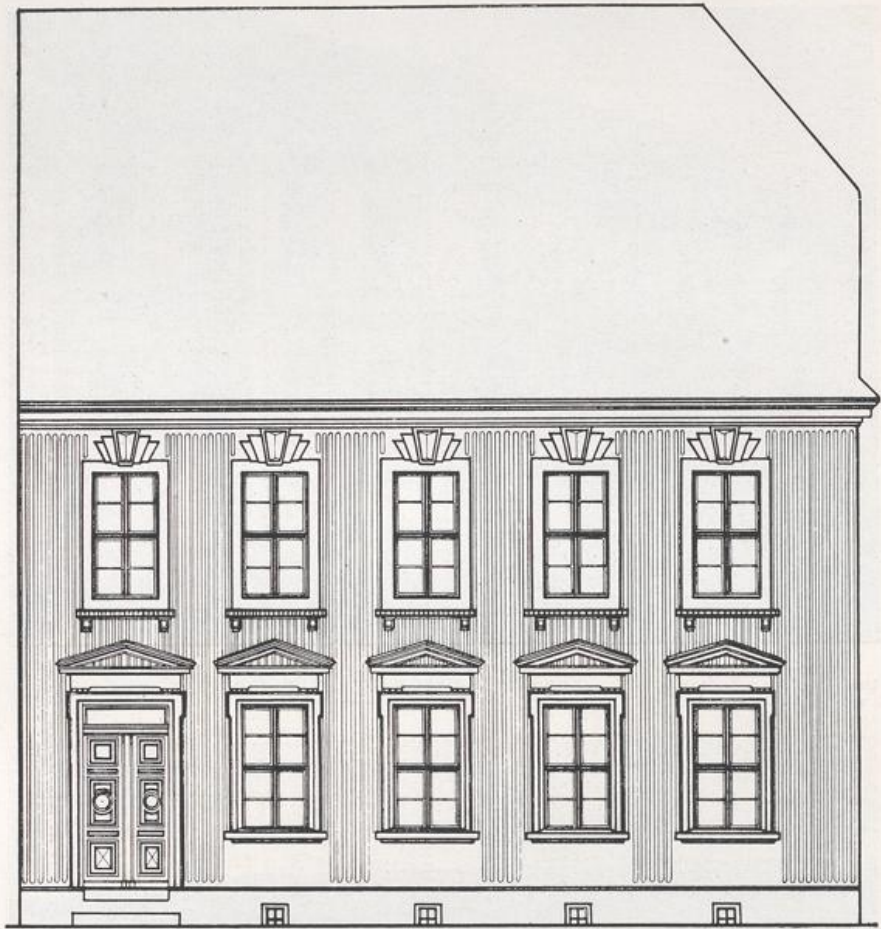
Haus Friedrich-Wilhelm-Straße 66 nach Braichs Entwurf
